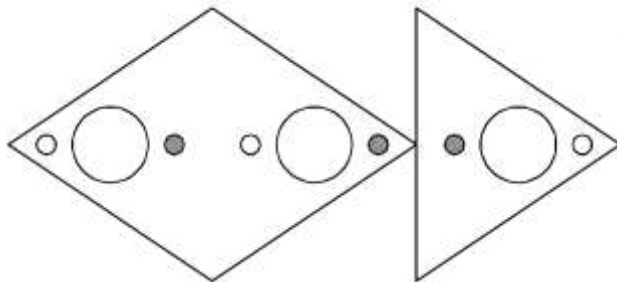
Topología de ensamblado de la segunda hilada del murete visto en planta
